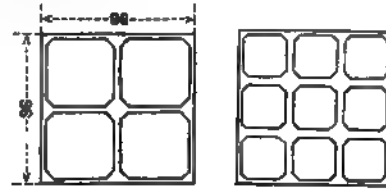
Hohlkörperdecke, System Ed. Züblin.
